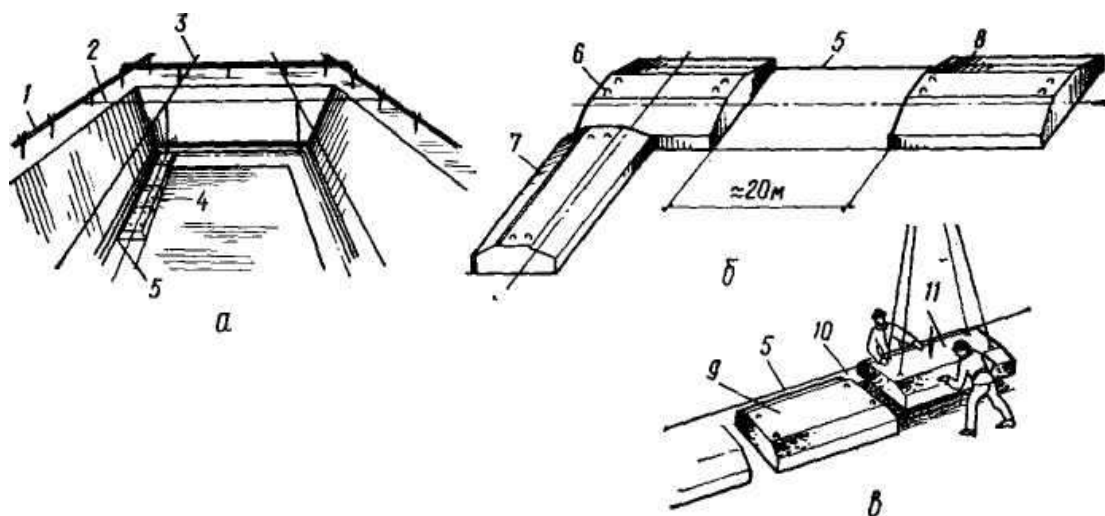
Схема розбивки та монтажу стрічкових фундаментів:
